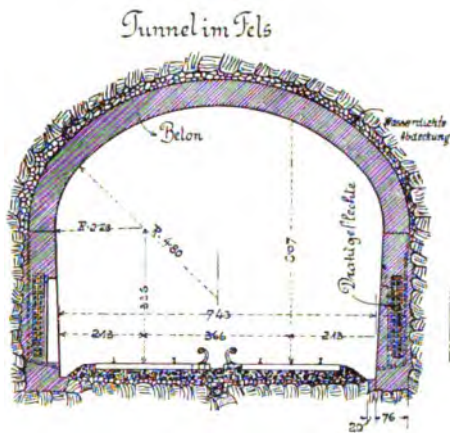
Querschnitt des St. Marry's Park Tunnels (Stampfbeton).
